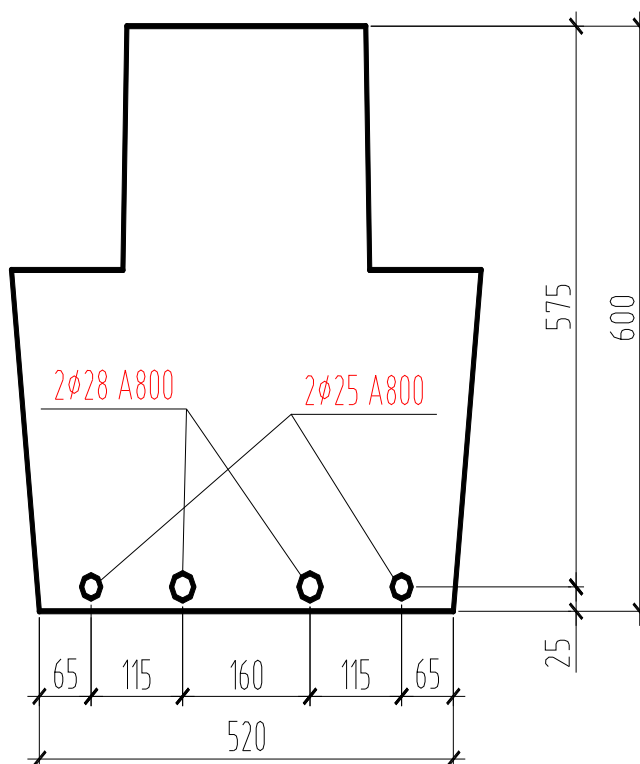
Розташування напруженої арматури в перерізі ригеля
